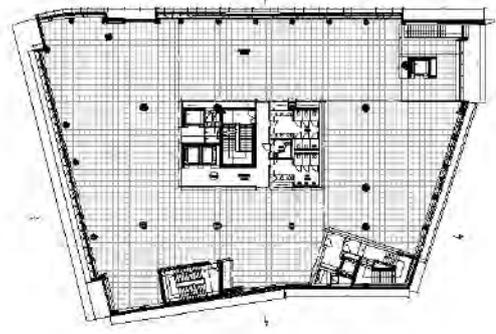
“Edifício Conde Barão” Projeto – Planta do piso-tipo (Fonte: Gesturbe, proc. 782/EDI/2016)
